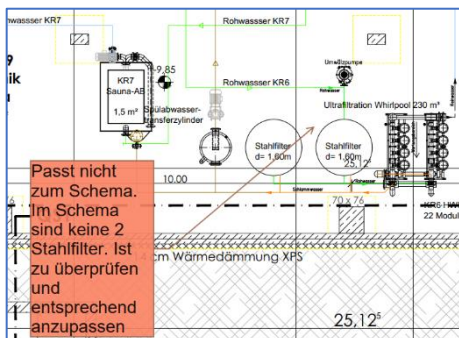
2.4.33 2021-10-22 905 472 Wassertechnik Grundriss E-2 Aufstellplan
